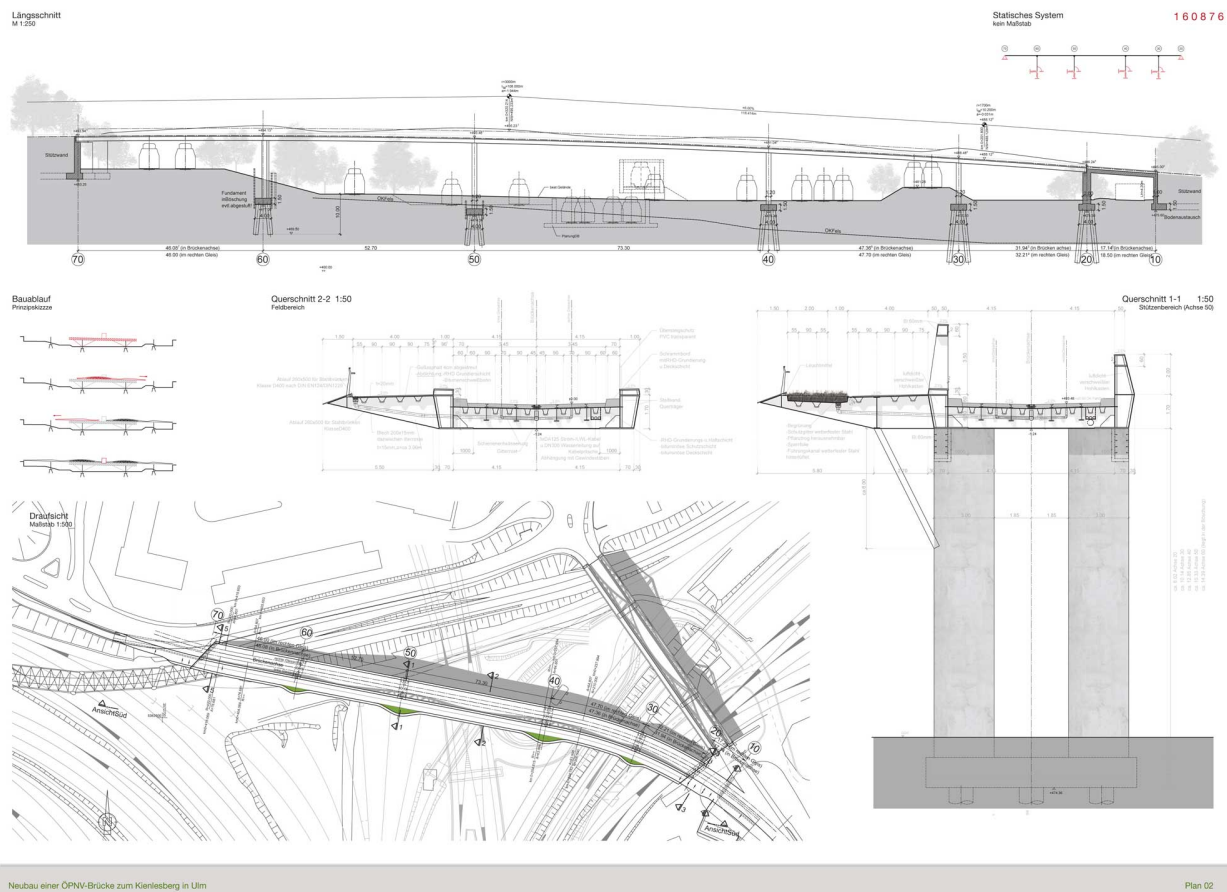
Grundriss und Schnitt der Baumaßnahme Kienlesbergbrücke<sup>4</sup>
